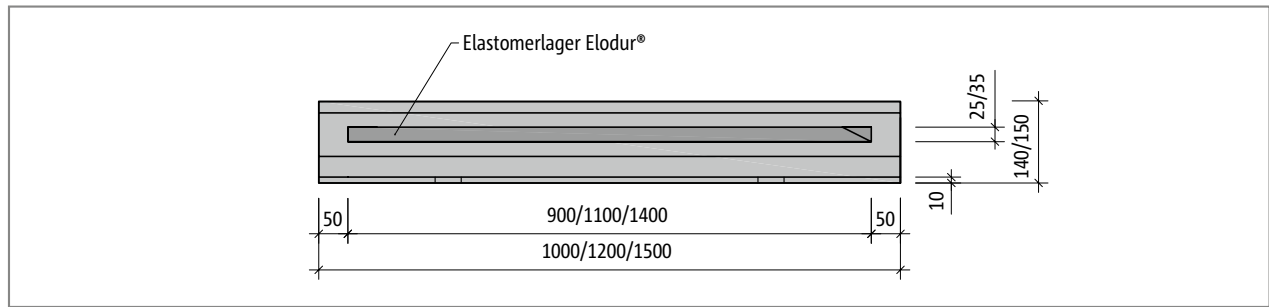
Schöck Tronsole® Typ BL: Grundriss
